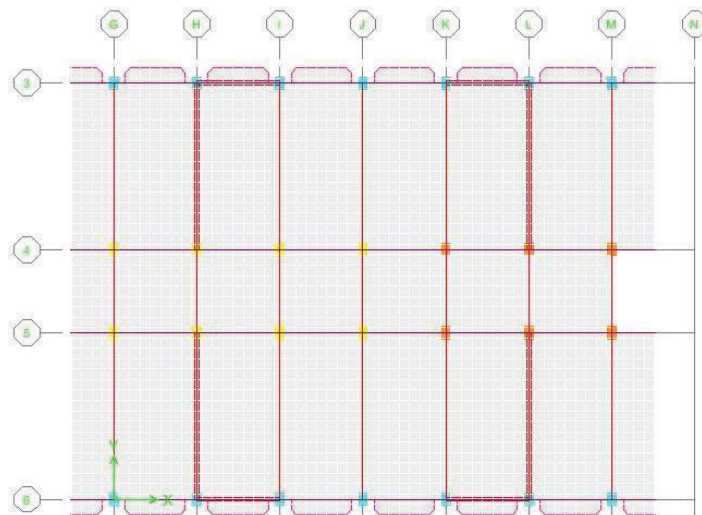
PLANTA DEL PRIMER PISO N+6.80 BLOQUE A
